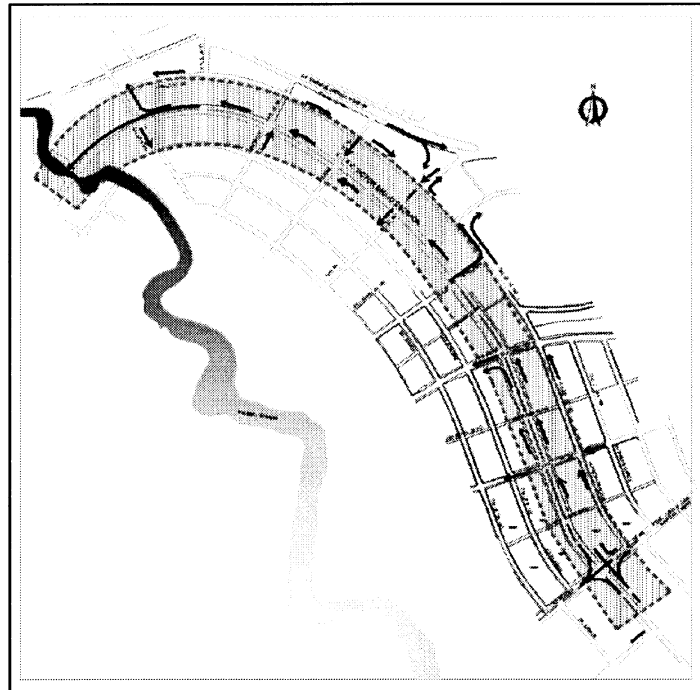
Propuesta de Reordenamiento vial en la Calle Víctor Emilio Estrada desde Av. 28 hasta Puente Miraflores
